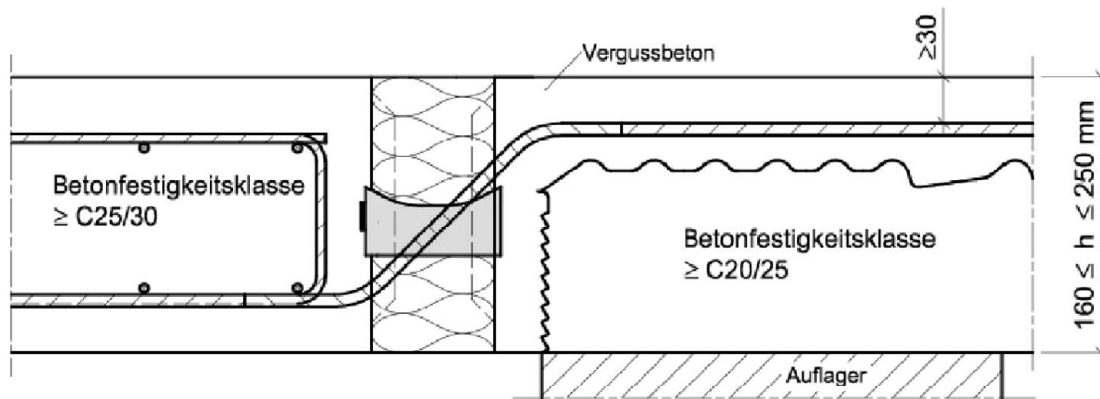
Schöck Isokorb® T Typ Q-ID mit Betondrucklager in eingebautem Zustand mit Vergussfuge
